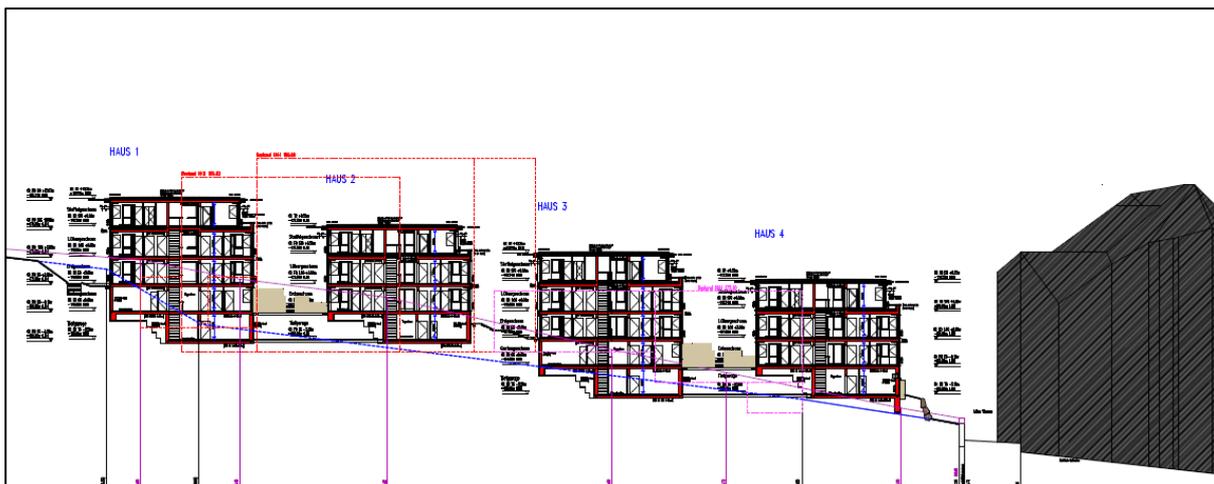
Schnitt von der Hospitalstraße (links) zur Löher Straße (rechts)
